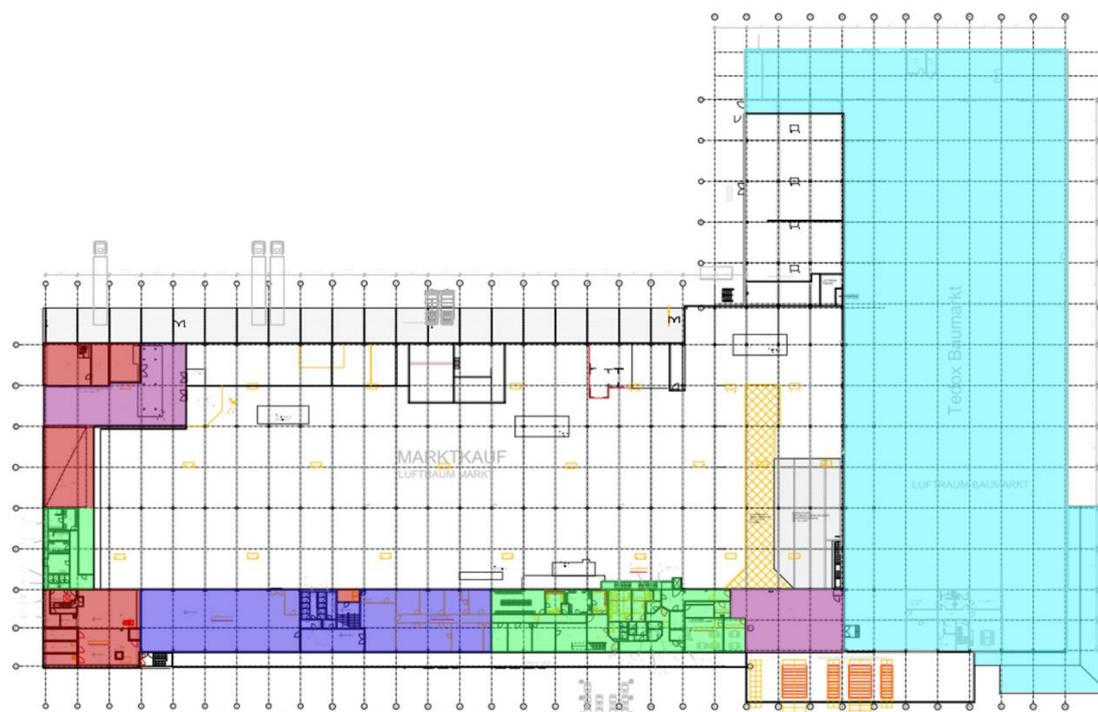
Grundriss Obergeschoss [2] bearbeitet
